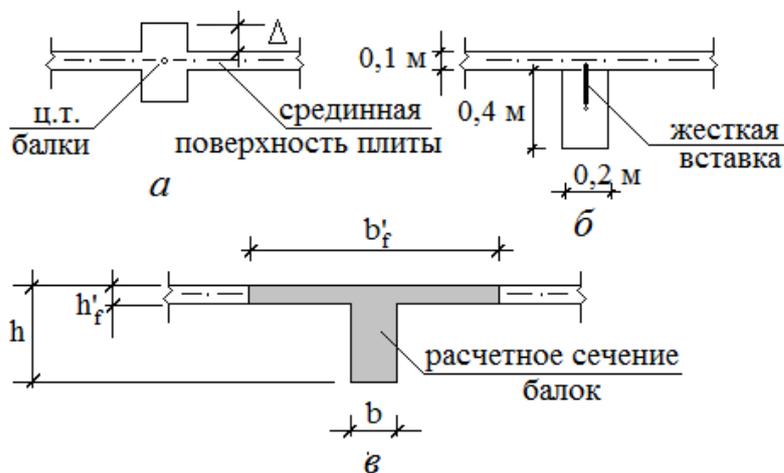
Моделирование расчетной схемы монолитного балочного перекрытия: а – расположение элементов расчетной схема на первом этапе ее построения; б – применение жесткой вставки стержней для смещение балок вниз на величину Δ ; в – расчетное сечение балок
